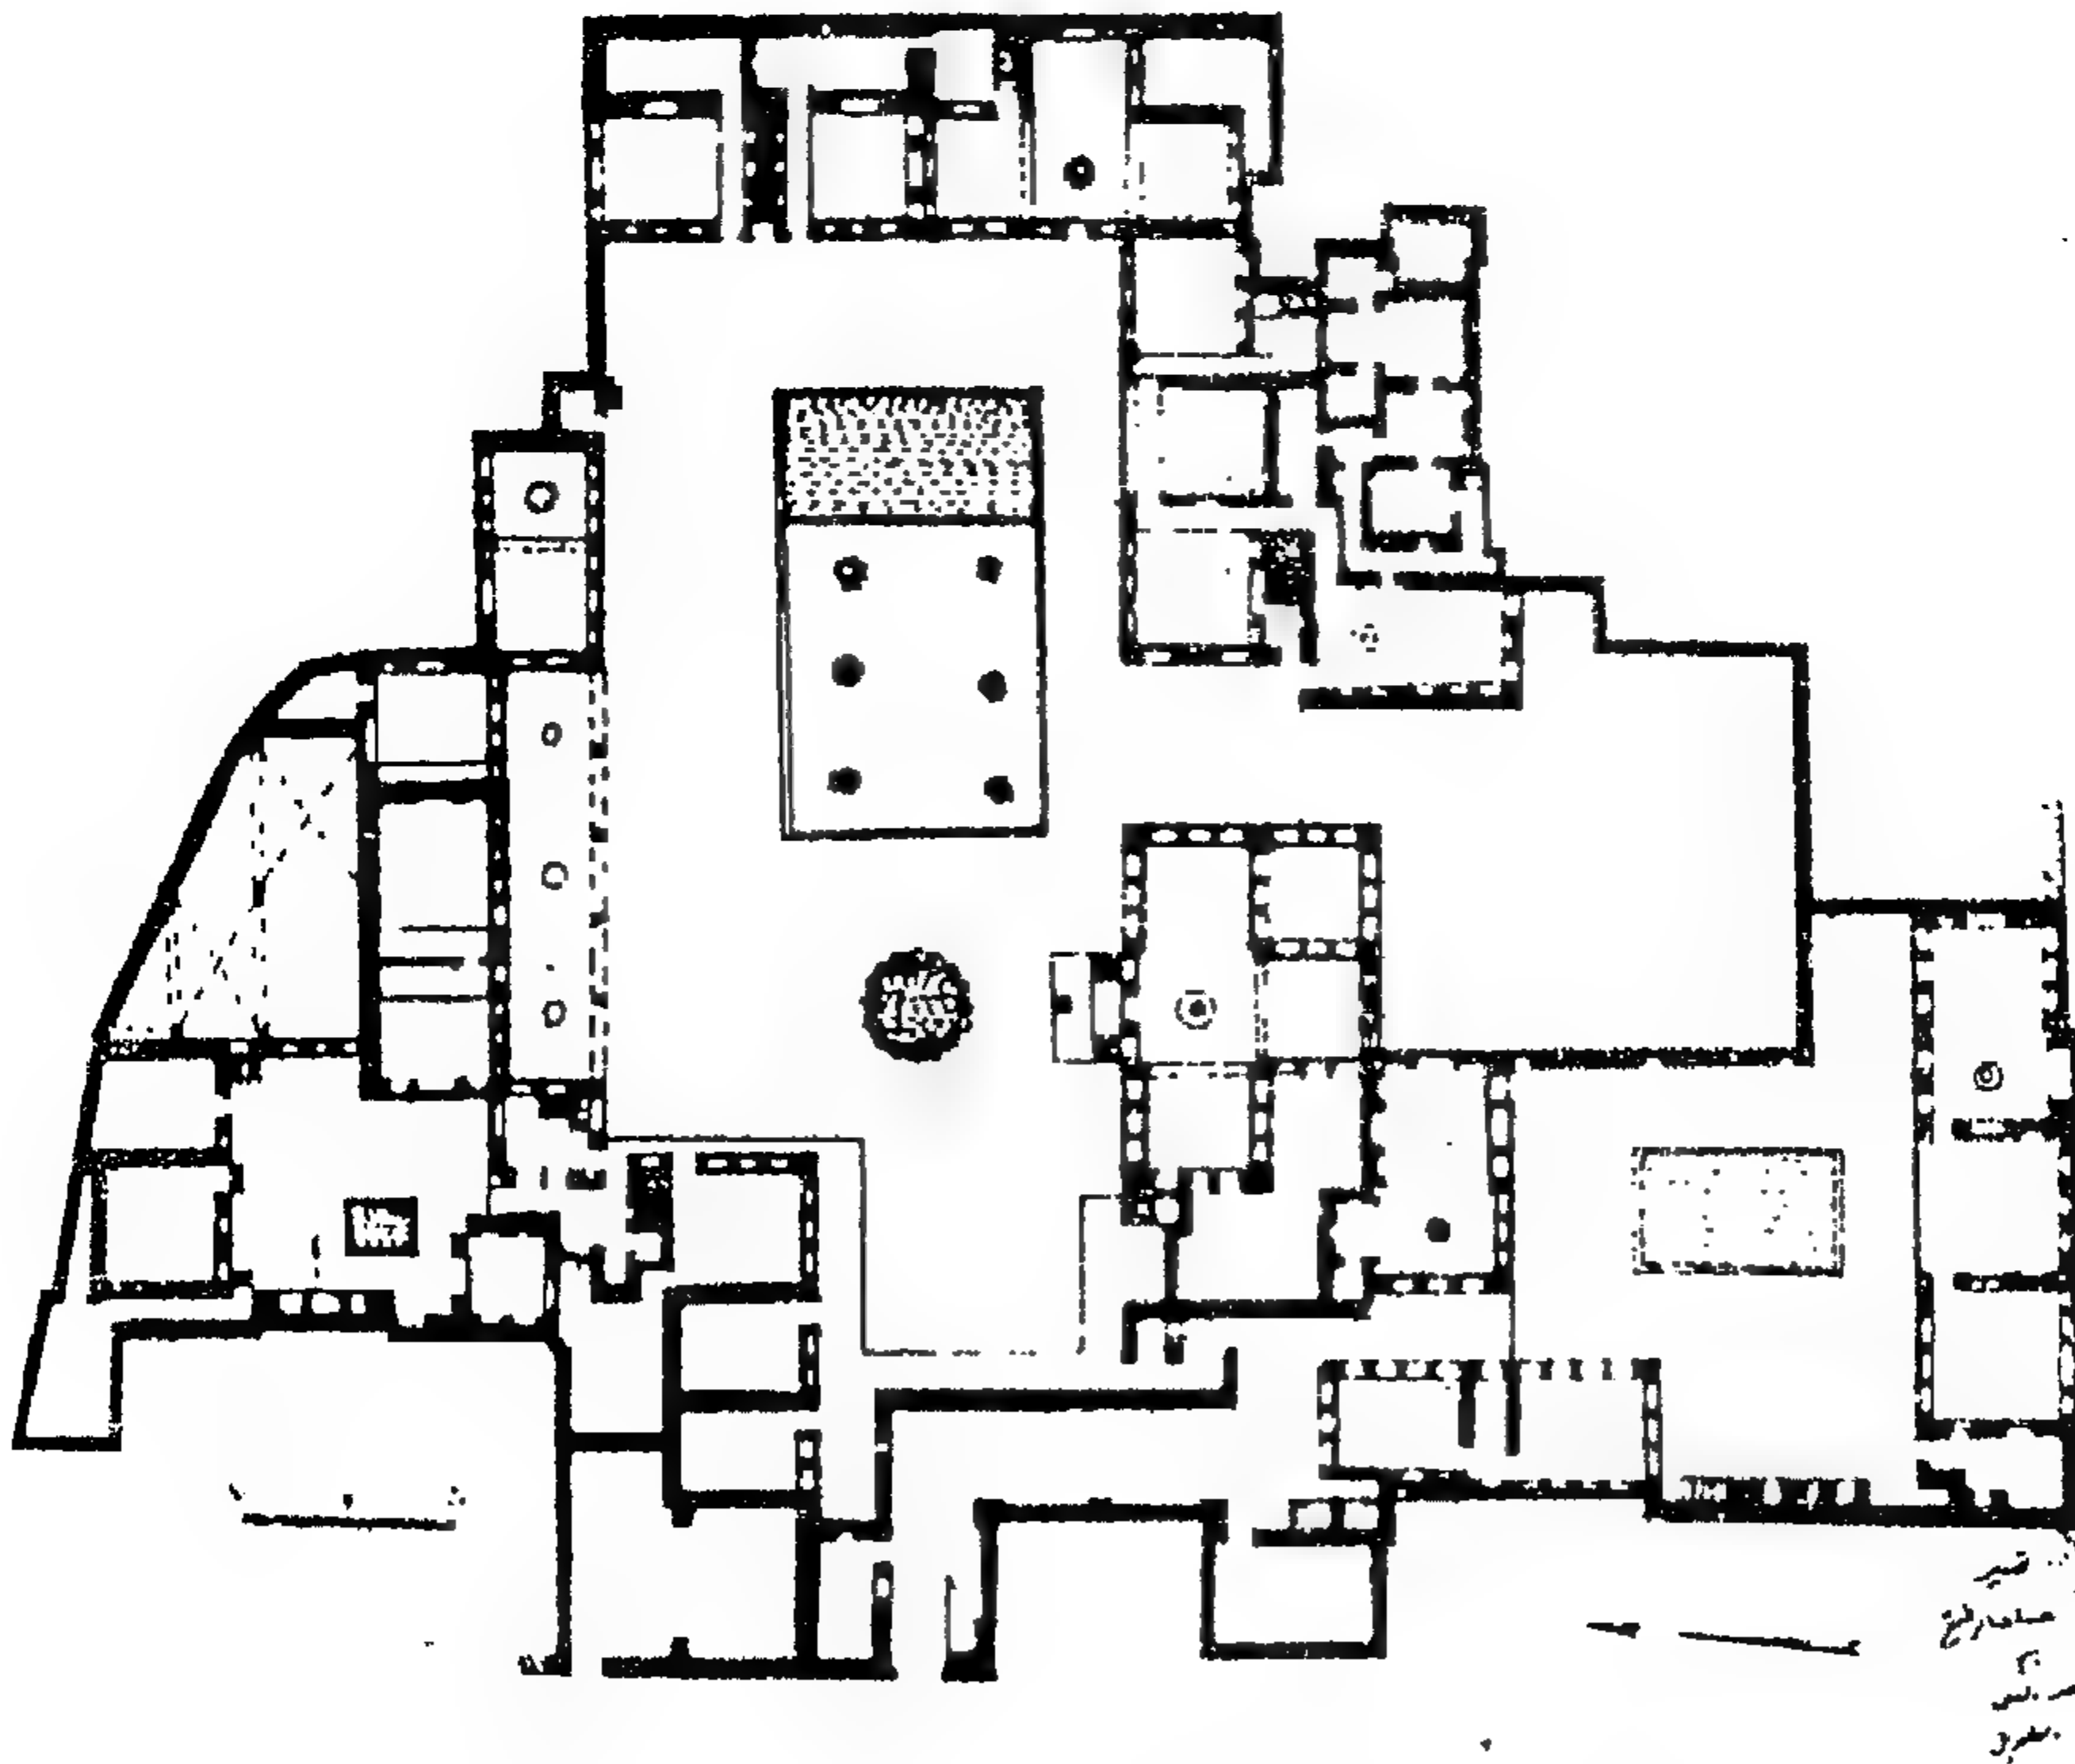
مسقط أفقي لقصر الحير الشرقي، تصور جرابار
